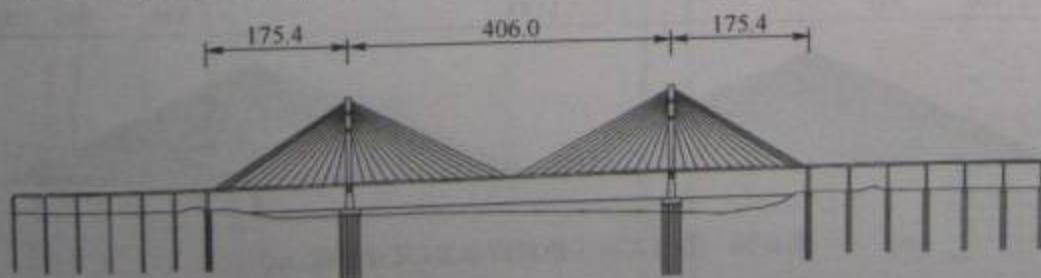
润扬大桥北汊斜拉桥(尺寸单位:m)
